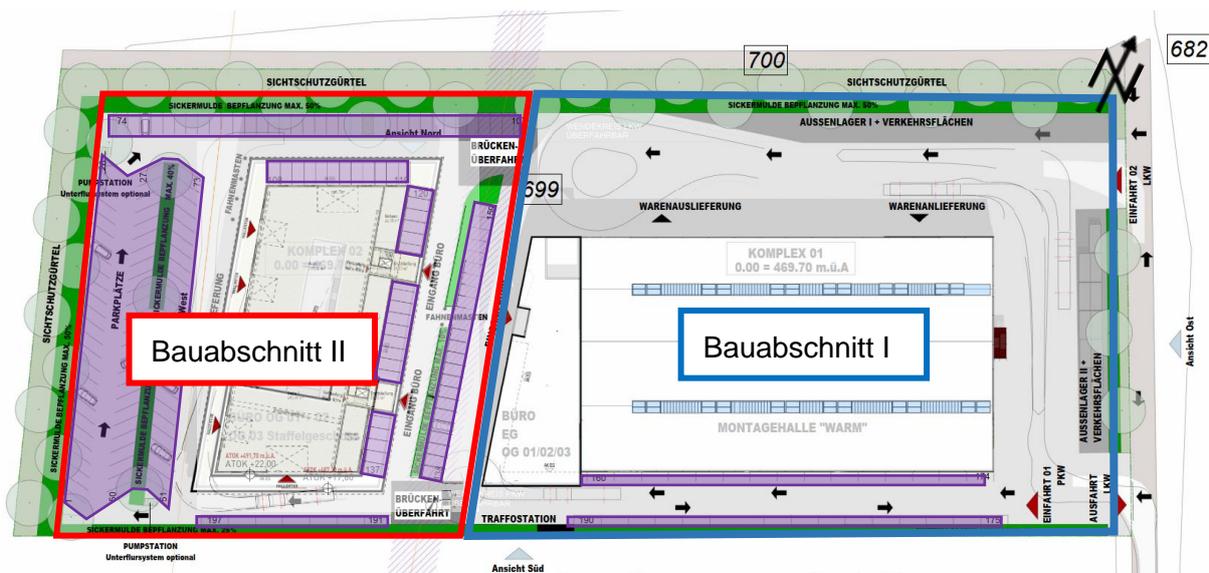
Lageplan Betriebsstandort RECON Oberaudorf (Stand 2025) [3], Parkplätze in lila
